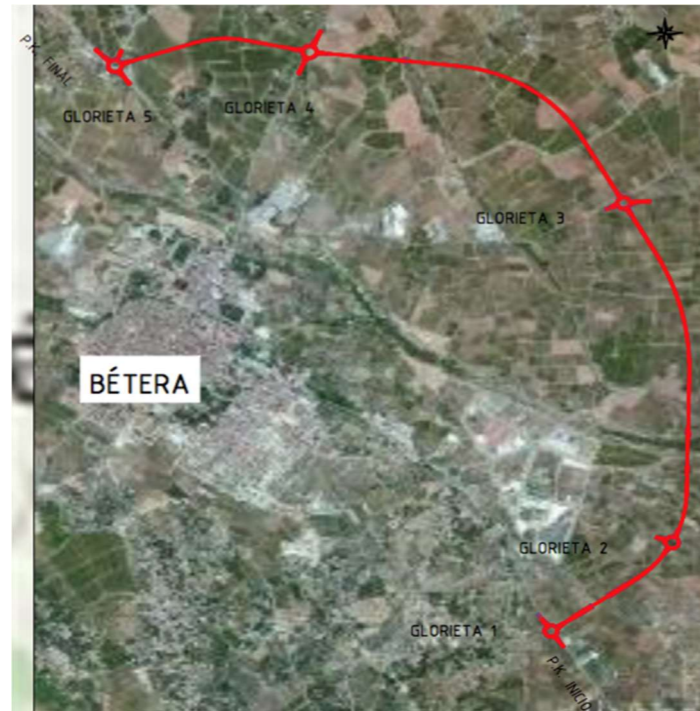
Figura II: TRAZADO EN PLANTA DE LA VARIANTE NORTE DE BÉTERA.
